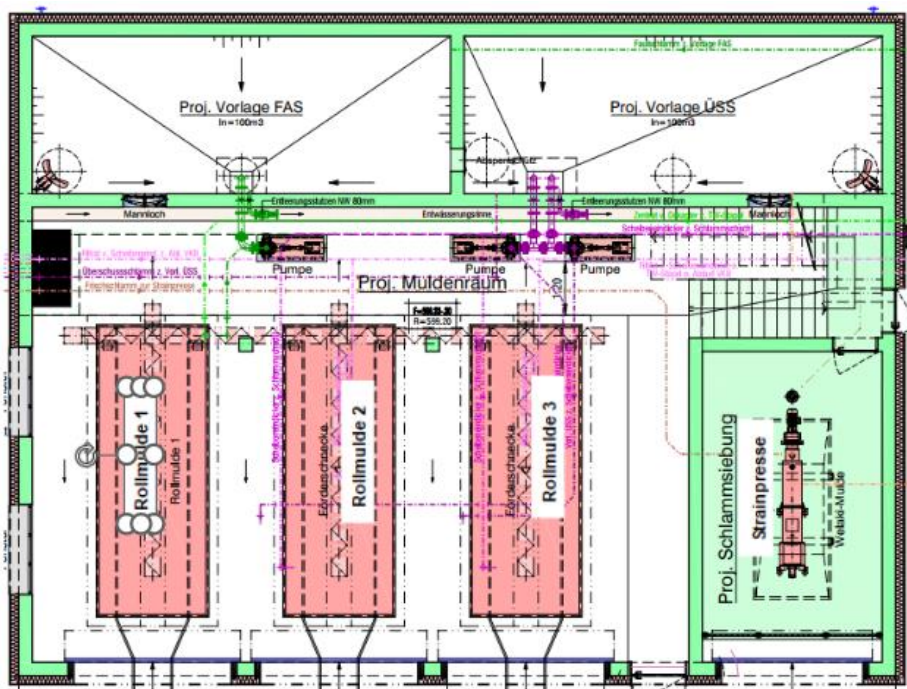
Schema des geplanten Gebäudes - Erdgeschoss
